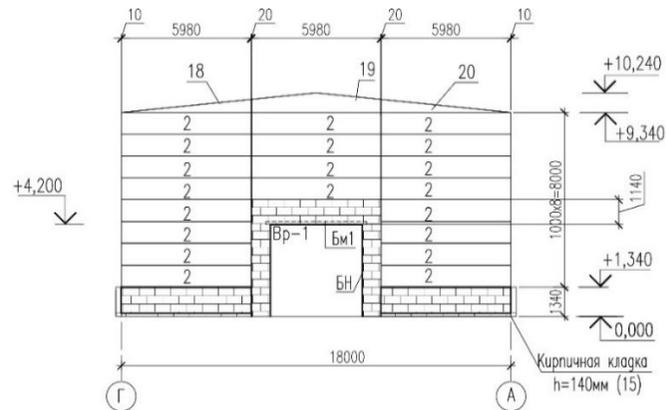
«Схема раскладки сэндвич-панелей на фасаде Г-А» [40]
